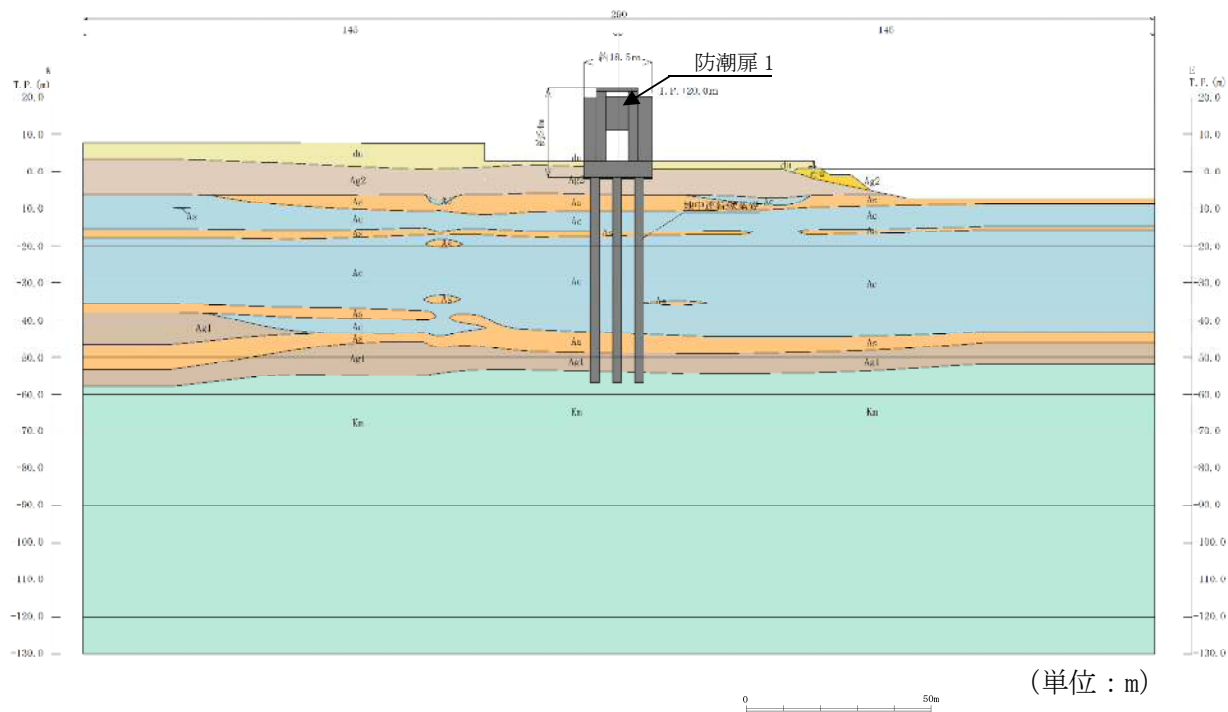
(8) 鉄筋コンクリート防潮壁 断面図(H-H断面)
